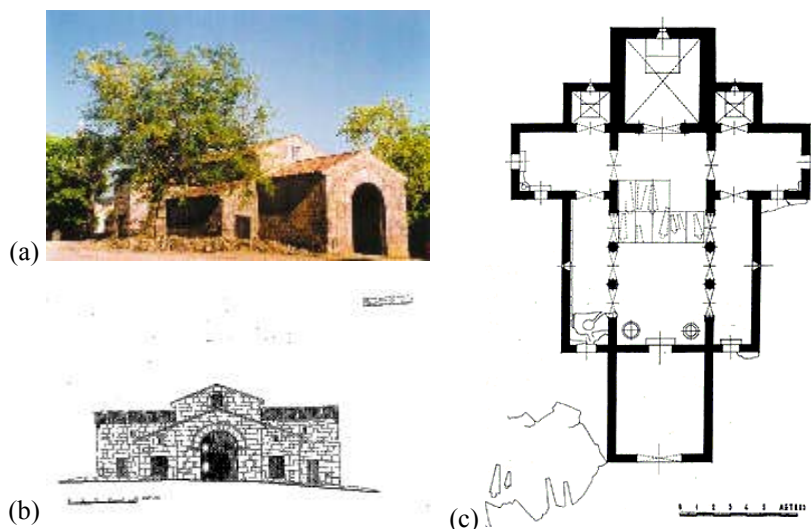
Peças desenhadas [Fonte: DGEMN]: (a) fotografia; (b) alçado da fachada (c) planta
